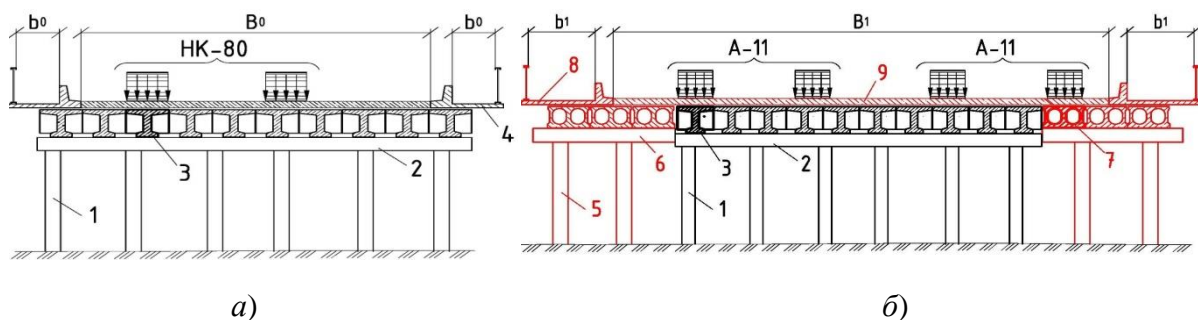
Переріз типового мосту: 1 – забивні палі; 2 – поперечна балка; 3 – струнубетонна балка; 4 – тротуарна плита; 5, 6 – додаткові опори та нарощена поперечна балка; 7 – додаткова балка з порожнинами для полегшення; 8 – розширена тротуарна плита; 9 – дорожнє покриття
